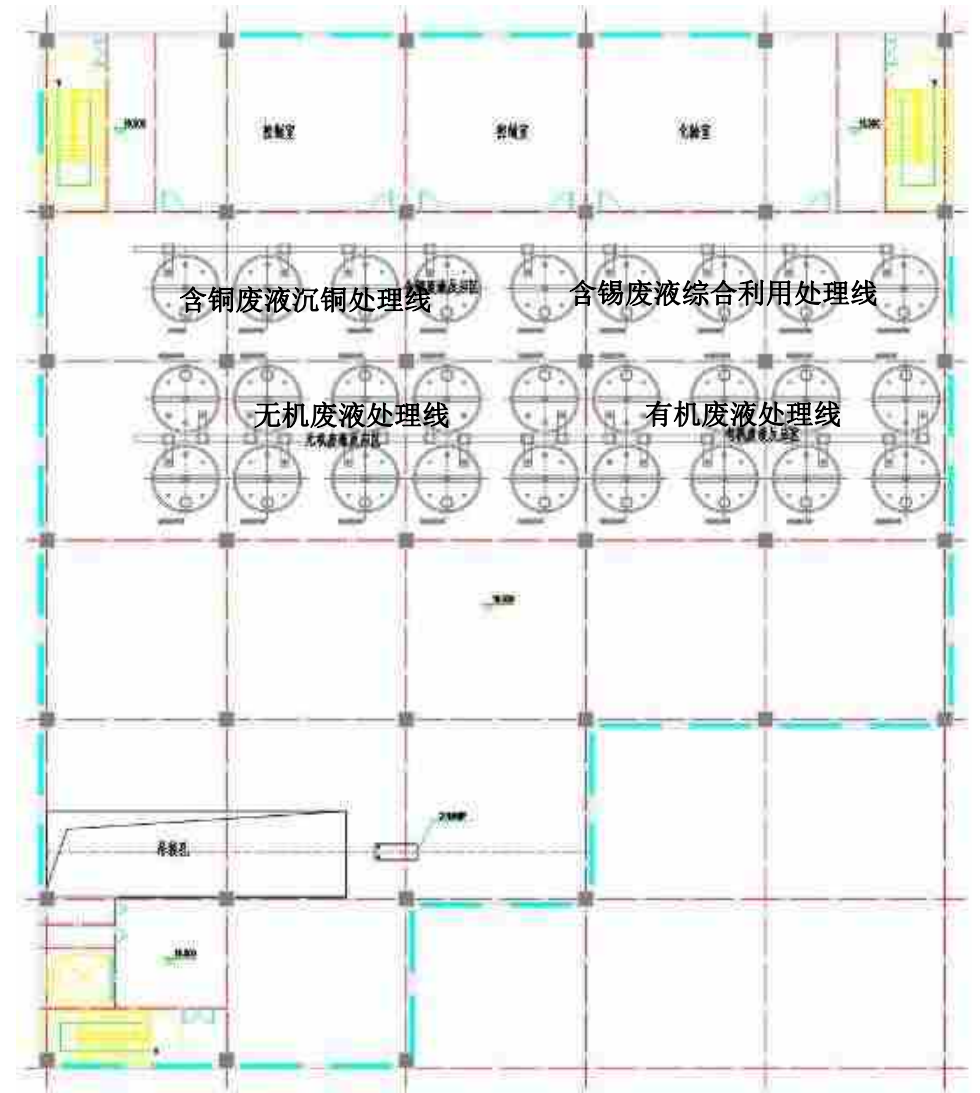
(4) 本次改扩建后 8#\*厂房 4 层平面布置图
